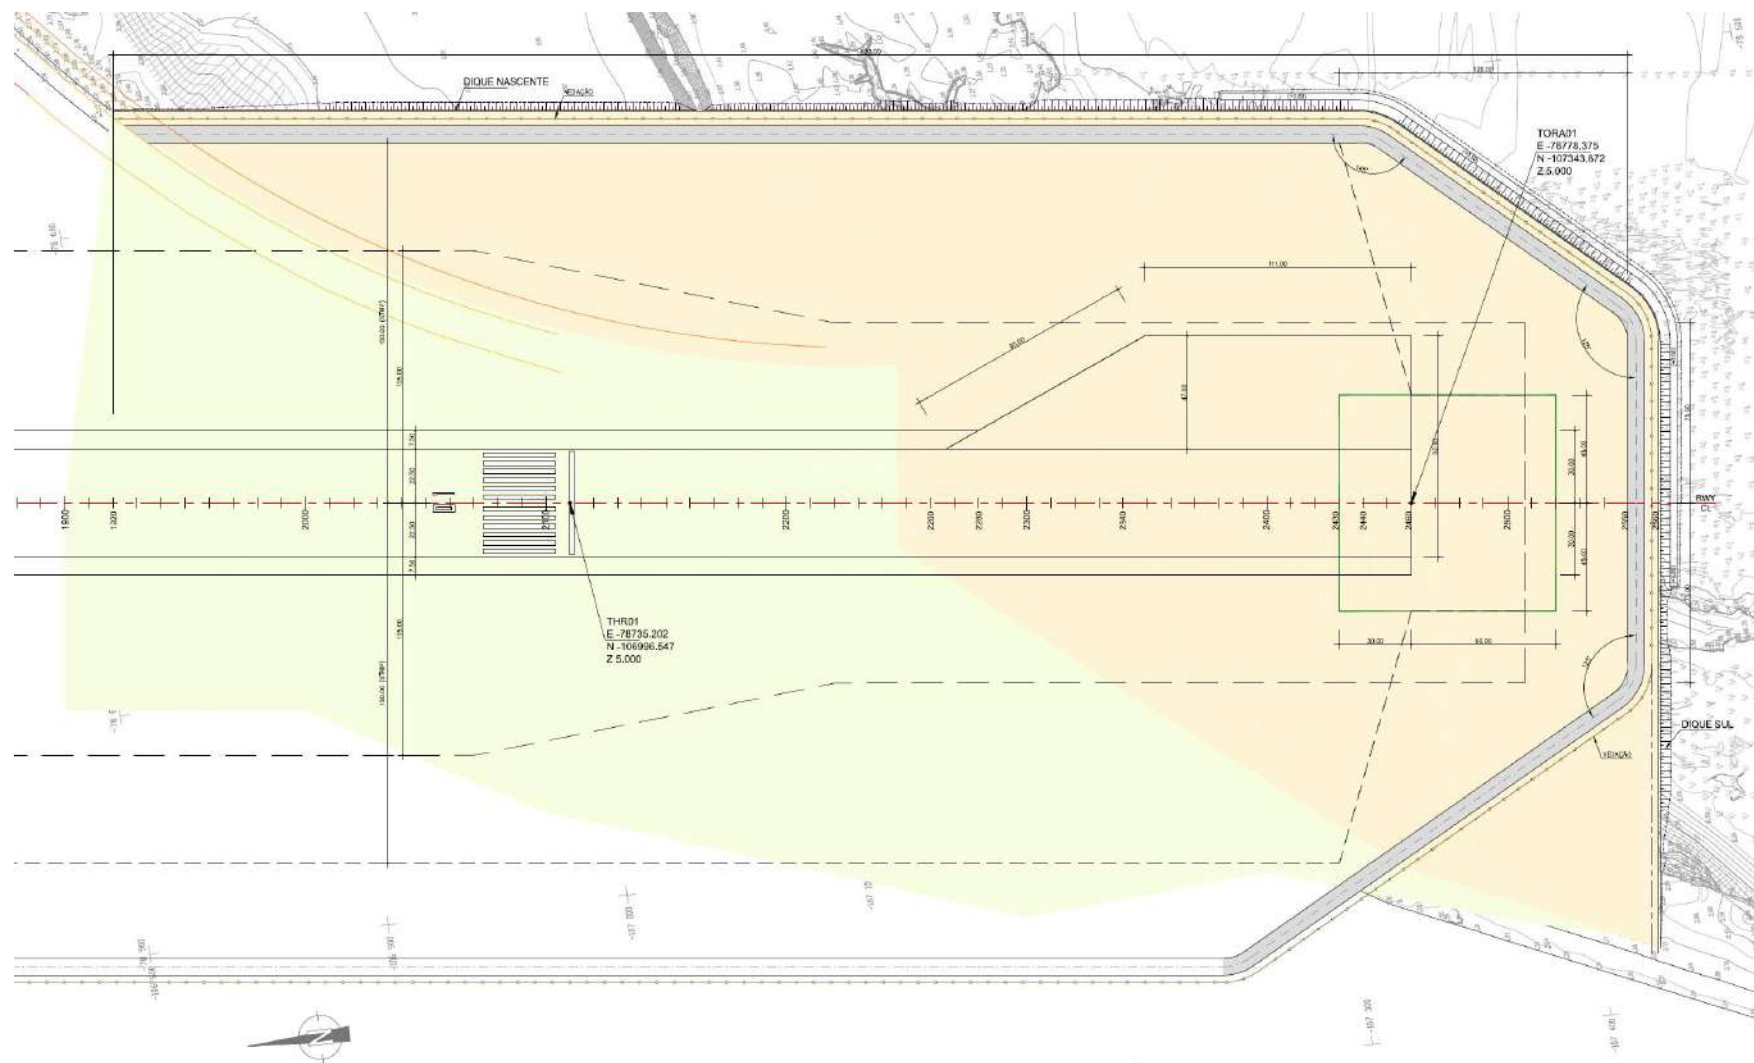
Área de implantação da Solução Alternativa 1 – Plataforma em aterro
